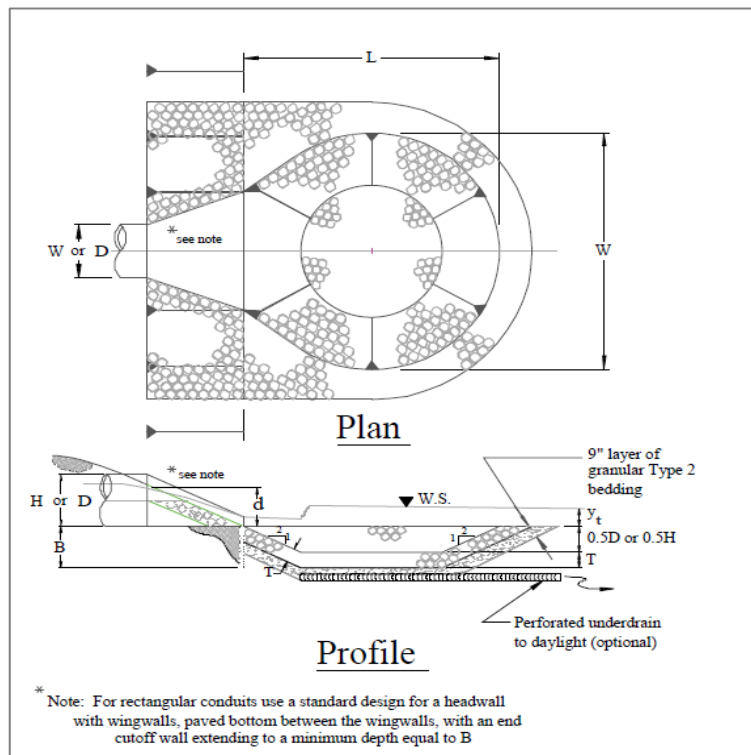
Cuenco preformado de enrocado a la salida de tuberías de alcantarillado pluvial
